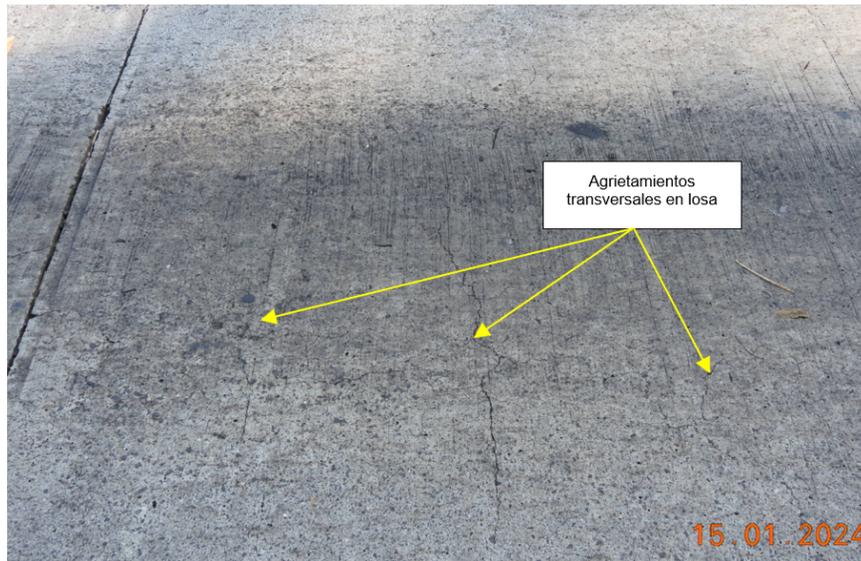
Agrietamientos en losa superestructura de chasis.
